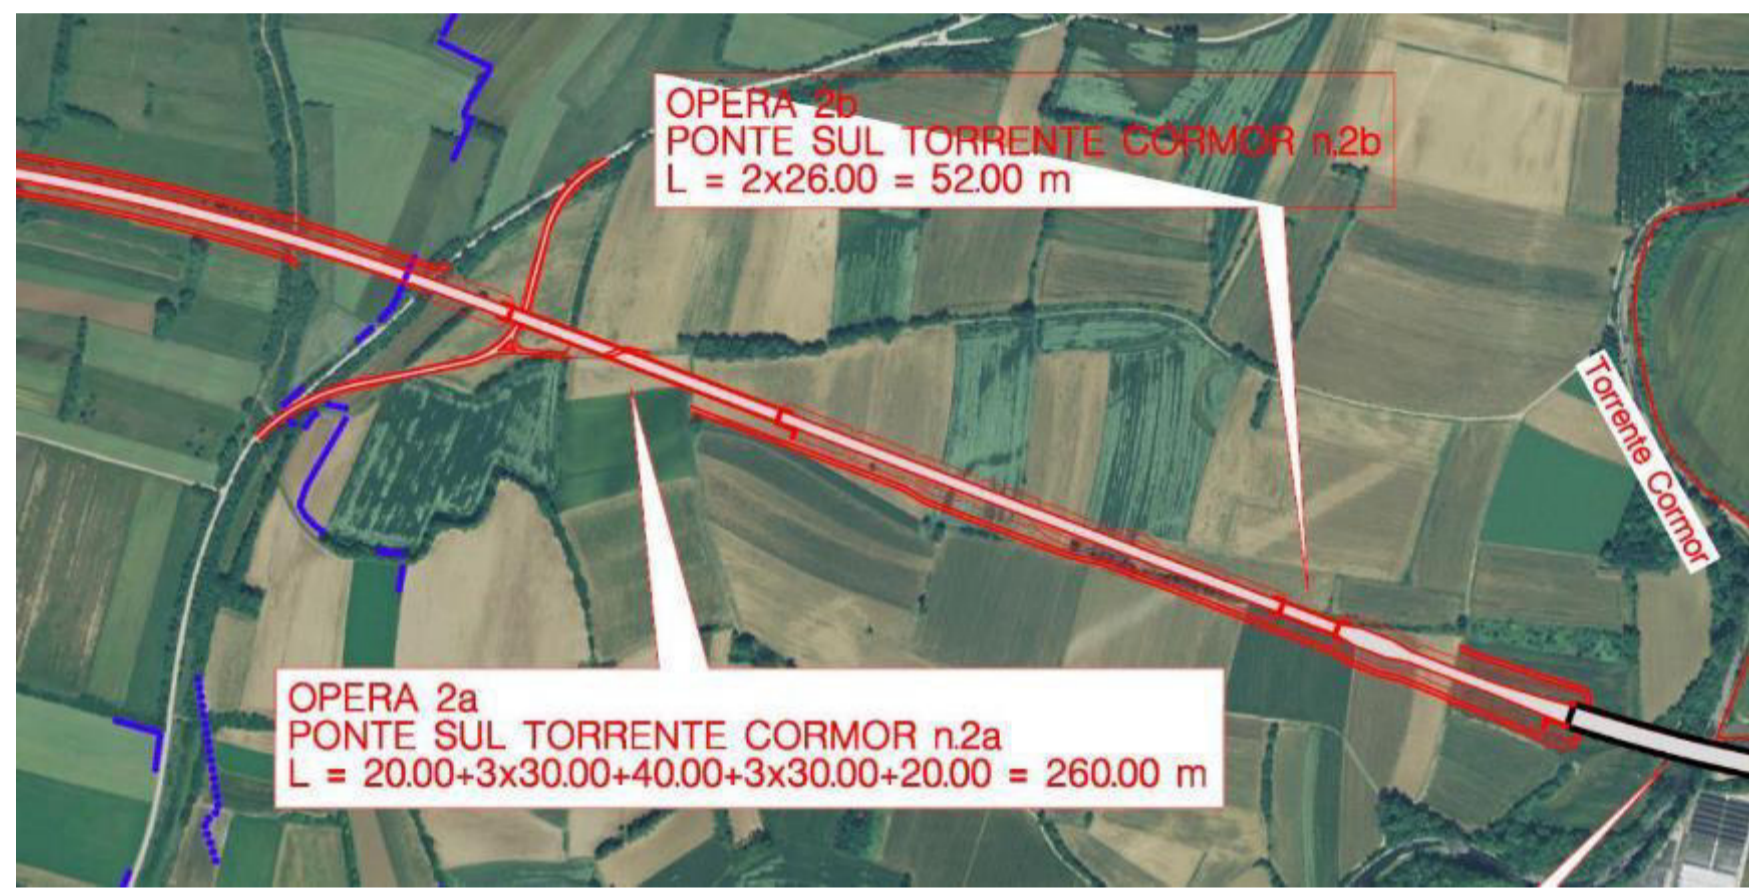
Estratto elab. A050000 di sovrapposizione del progetto su ortofoto
